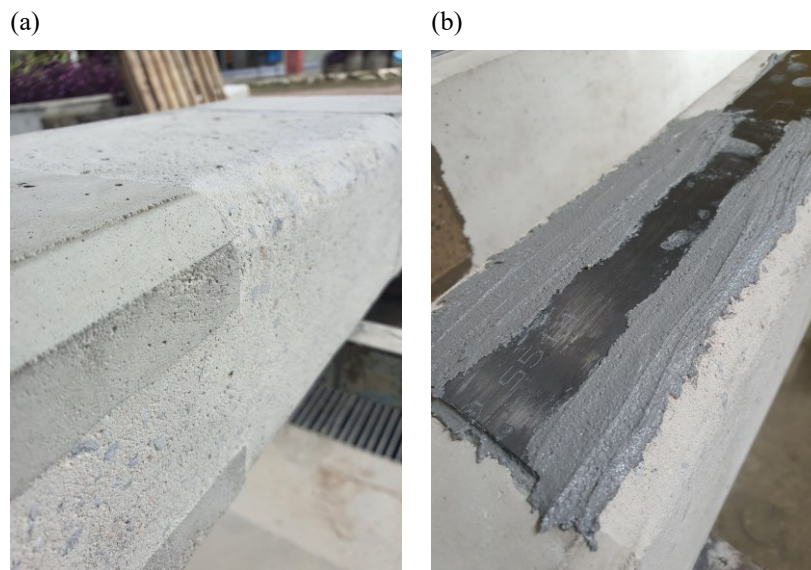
(a) aplicação da resina; (b) laminado fixado a viga após o uso do rolo para tiragem de bolhas de ar
